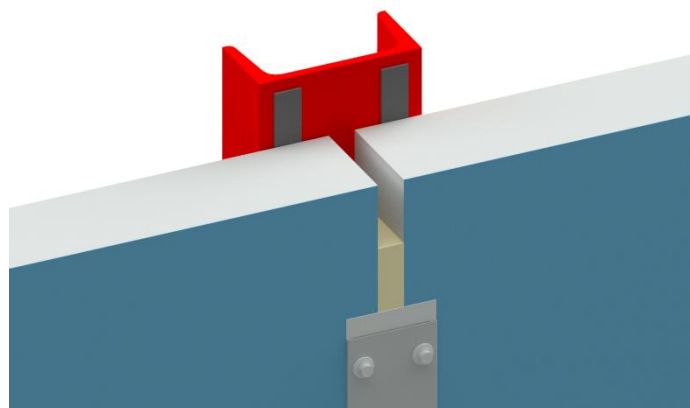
Traitement d'une jonction verticale avec panneaux sandwich isolants posés horizontalement – Bardages dits à « joints fermés »
